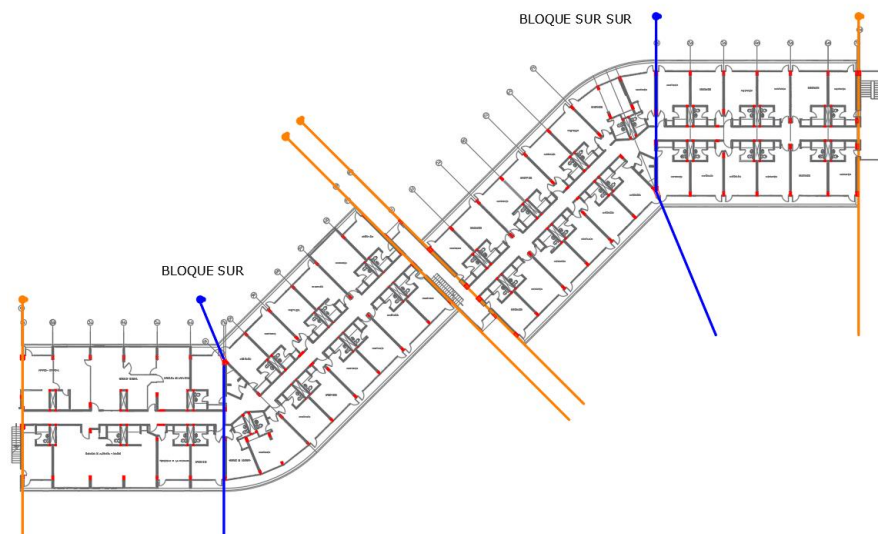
Planta Bloque Sur Sur y Bloque Sur
